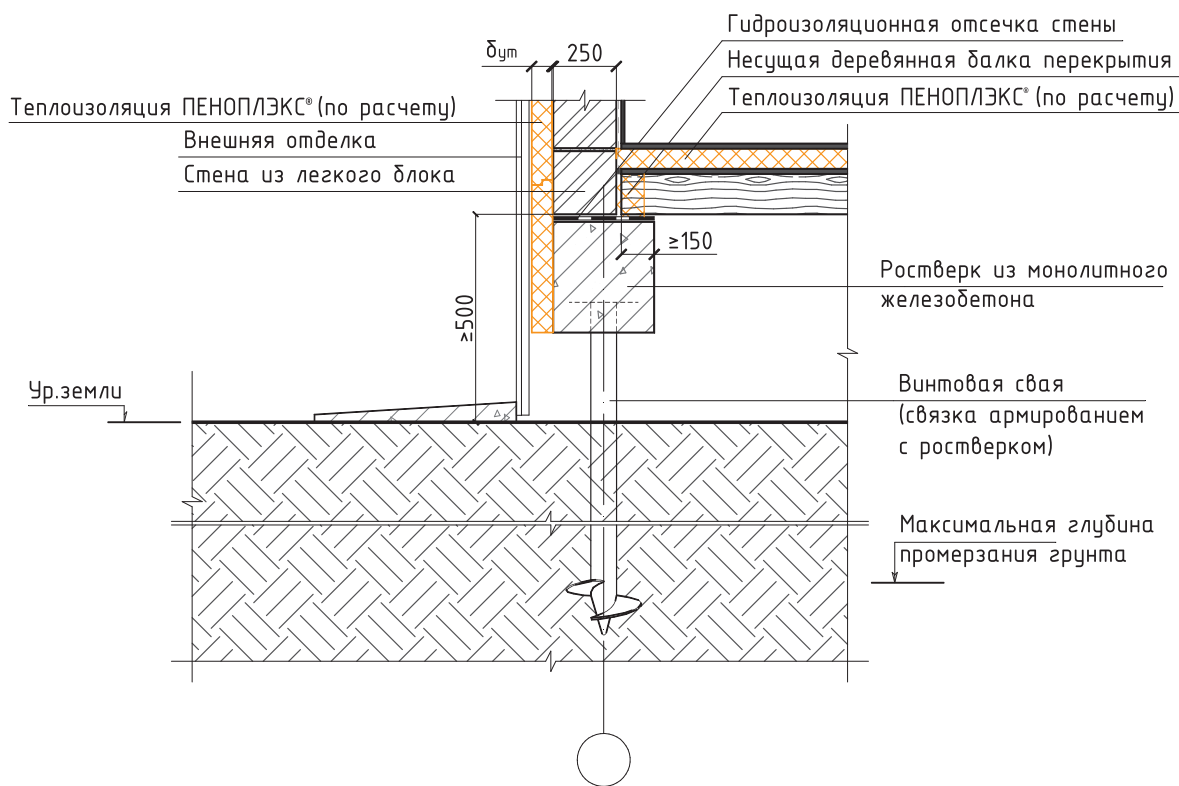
Схема сопряжения свайно-ростверкового фундамента и стены из облегченных блоков.
